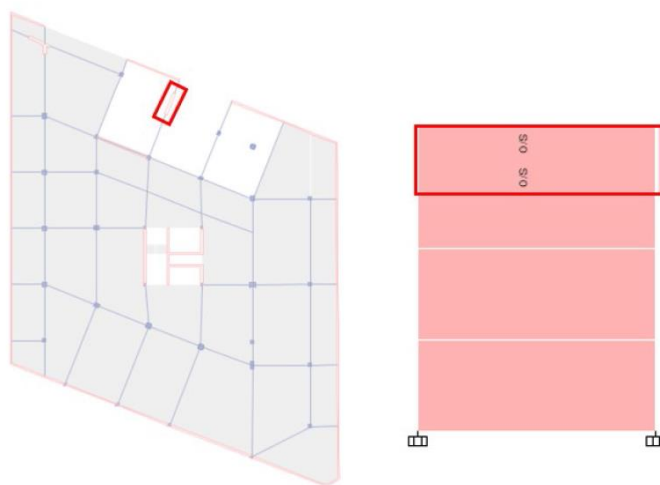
Ubicaciones de columnas a reforzar en los niveles 4 a 6
